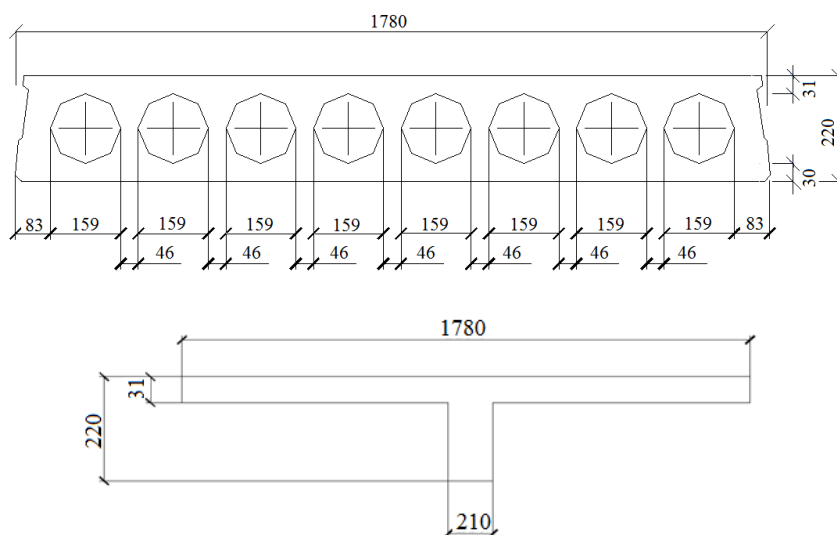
Дійсний і розрахунковий перерізи плити перекриття з круглими порожнинами шириною 1,78 м
